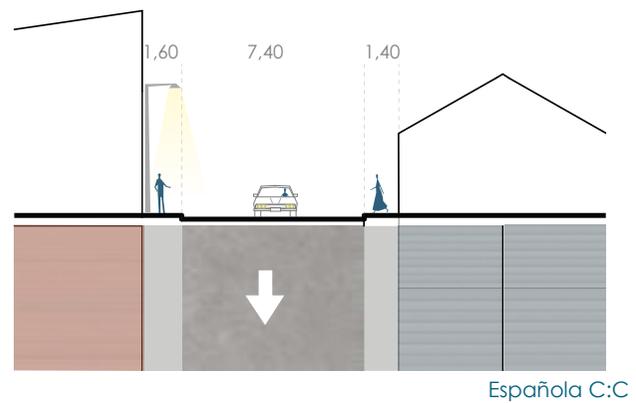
Secciones Viales. Fuente: Elaboración Propia
